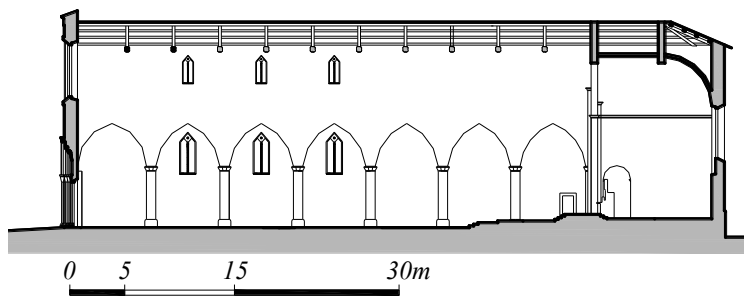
Chiesa di S. Silvestro: Sezione longitudinale
